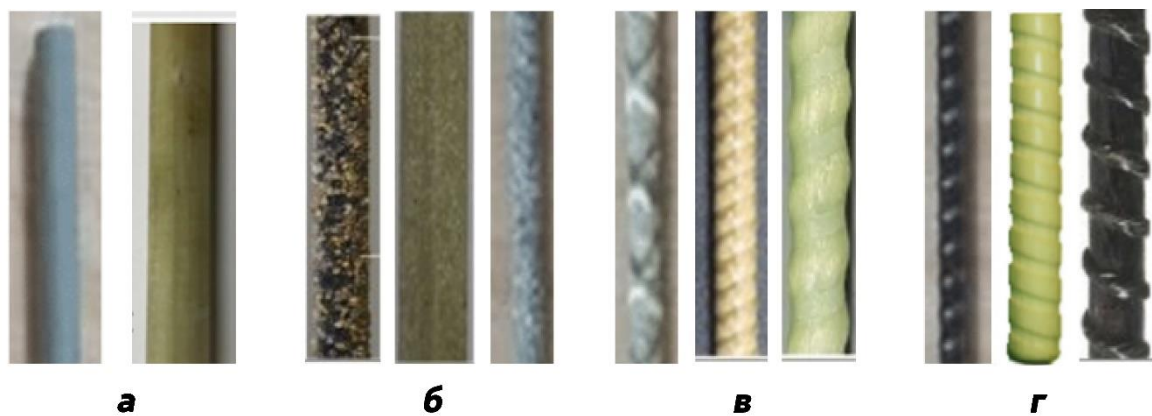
Різні типи поверхні арматури: а) гладкі, б) з пісчаним покриттям, в) плетені, г) ребристі
